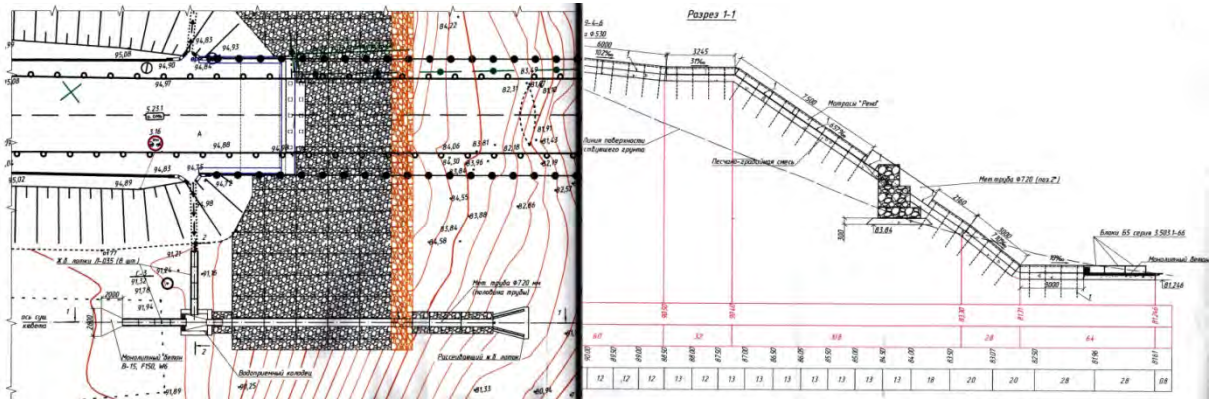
План и поперечный разрез участка берегоукрепительных работ
